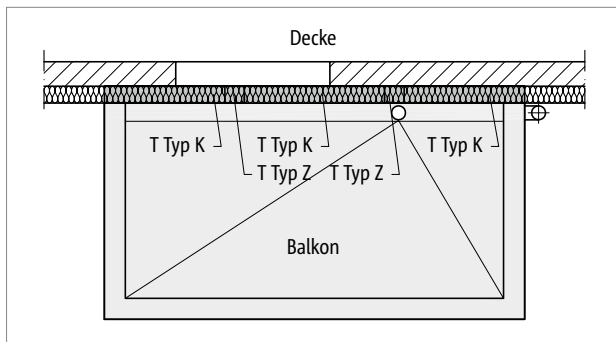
Schöck Isokorb® XT Typ Z, K: Aussparung für Entwässerung mit Schöck Isokorb® XT Typ Z
